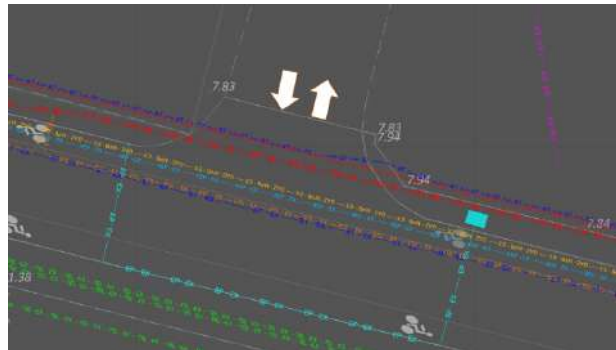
Plan des réseaux existants sur l'entrée du site.
